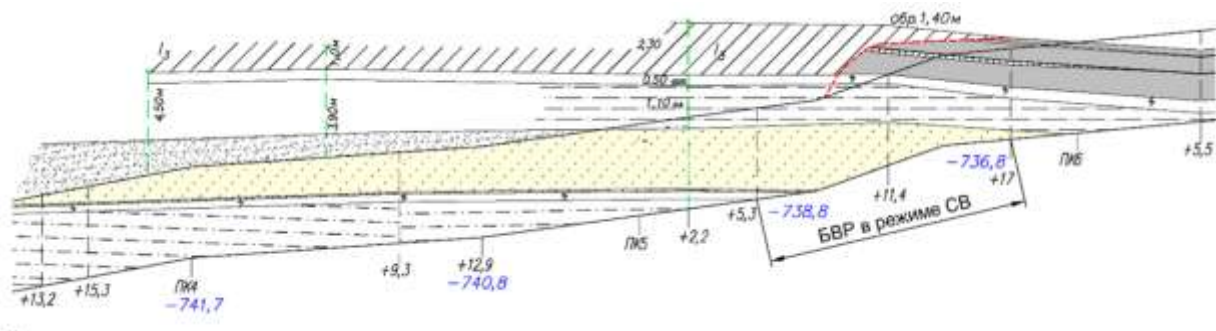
Геологический разрез по трассе вскрывающей выработки угольный пласт l_3
